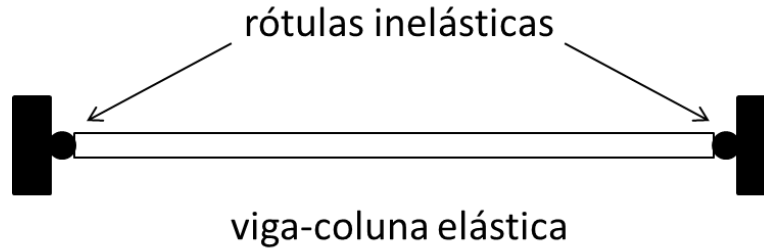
Elemento de pórtico plano no modelo de dissipação concentrada.
